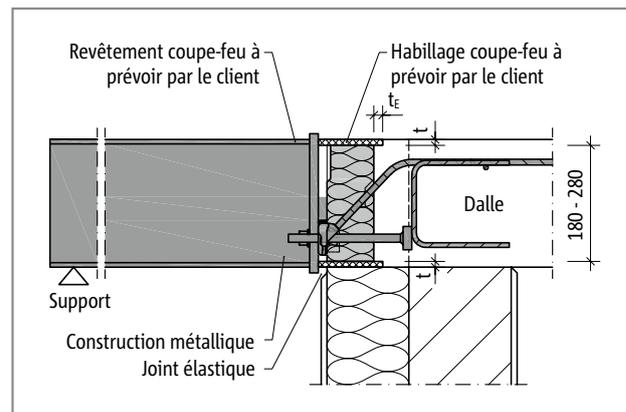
Schöck Isokorb® T type SQ : Bardage de protection incendie sur site - T type SQ, construction en acier avec revêtement de protection incendie ; coupe
